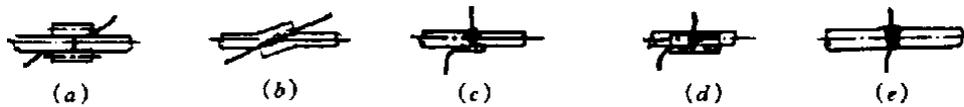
钢筋电弧焊接头拉伸试验断于焊缝示意图
